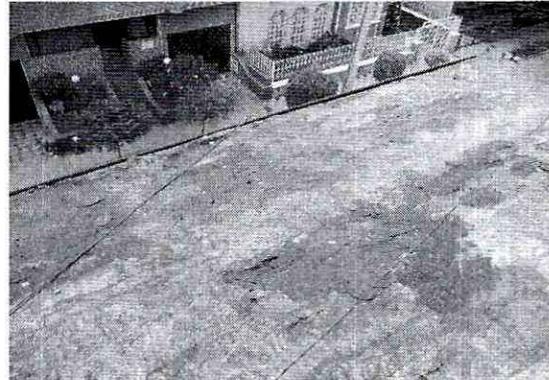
Estado actual de la cubierta en voladizo hacia la parte intermedia de la edificación. Se observa un deterioro progresivo de la cubierta debido a la falta de mantenimiento.
